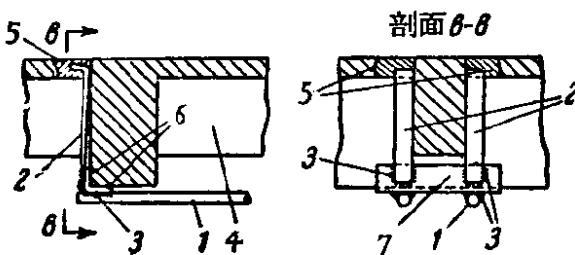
钢筋混凝土构件中间支座上水平补强拉杆的锚固装置结构
